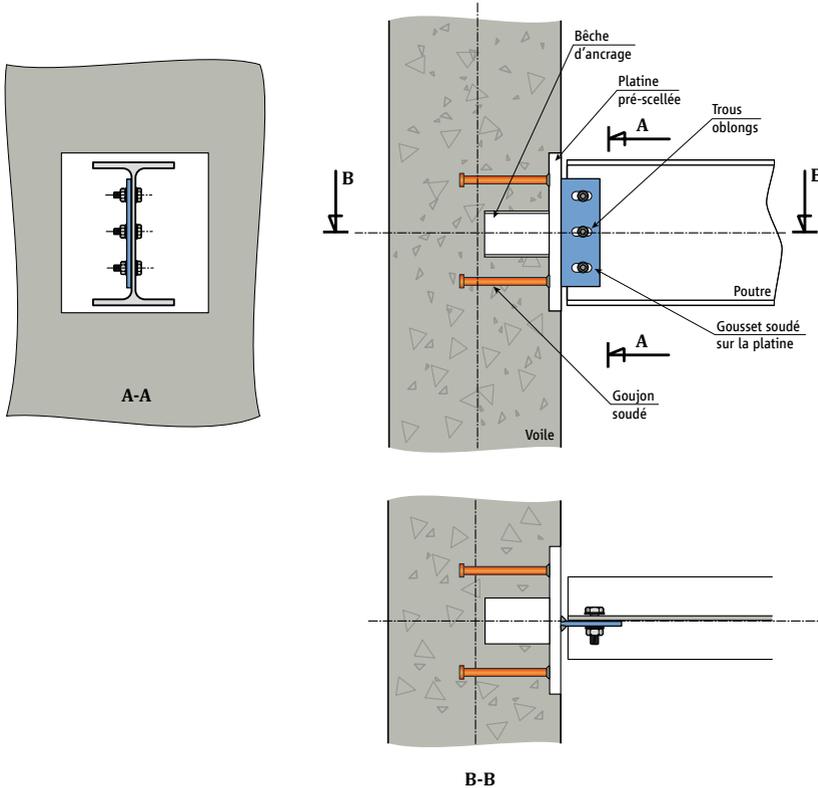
Ancrages dans un voile par platine pré-scannée avec goujons soudés
